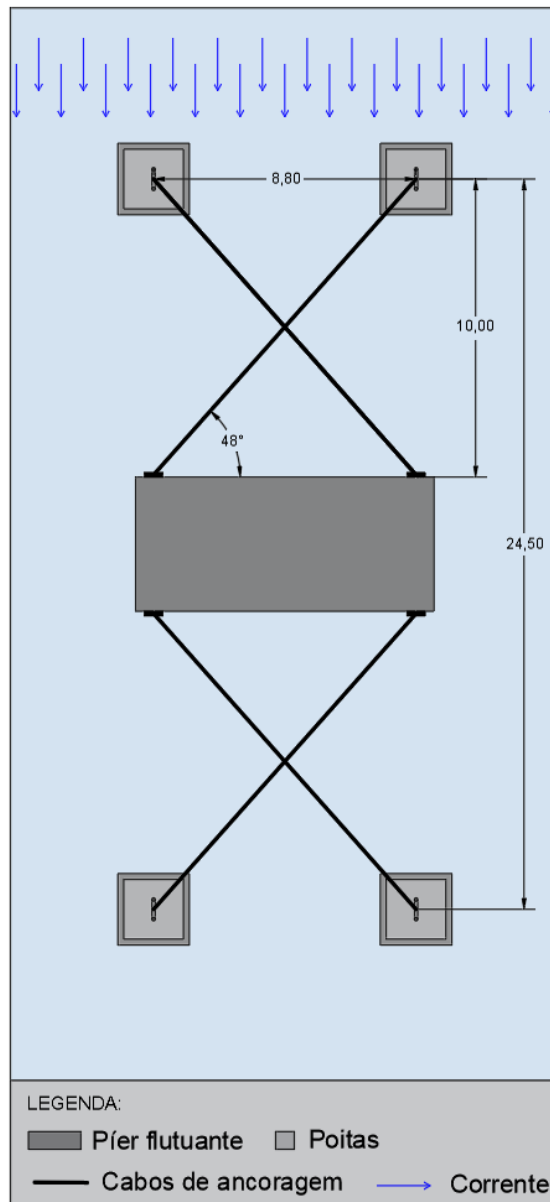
Vista superior do *layout* do sistema de fundeio proposto.
